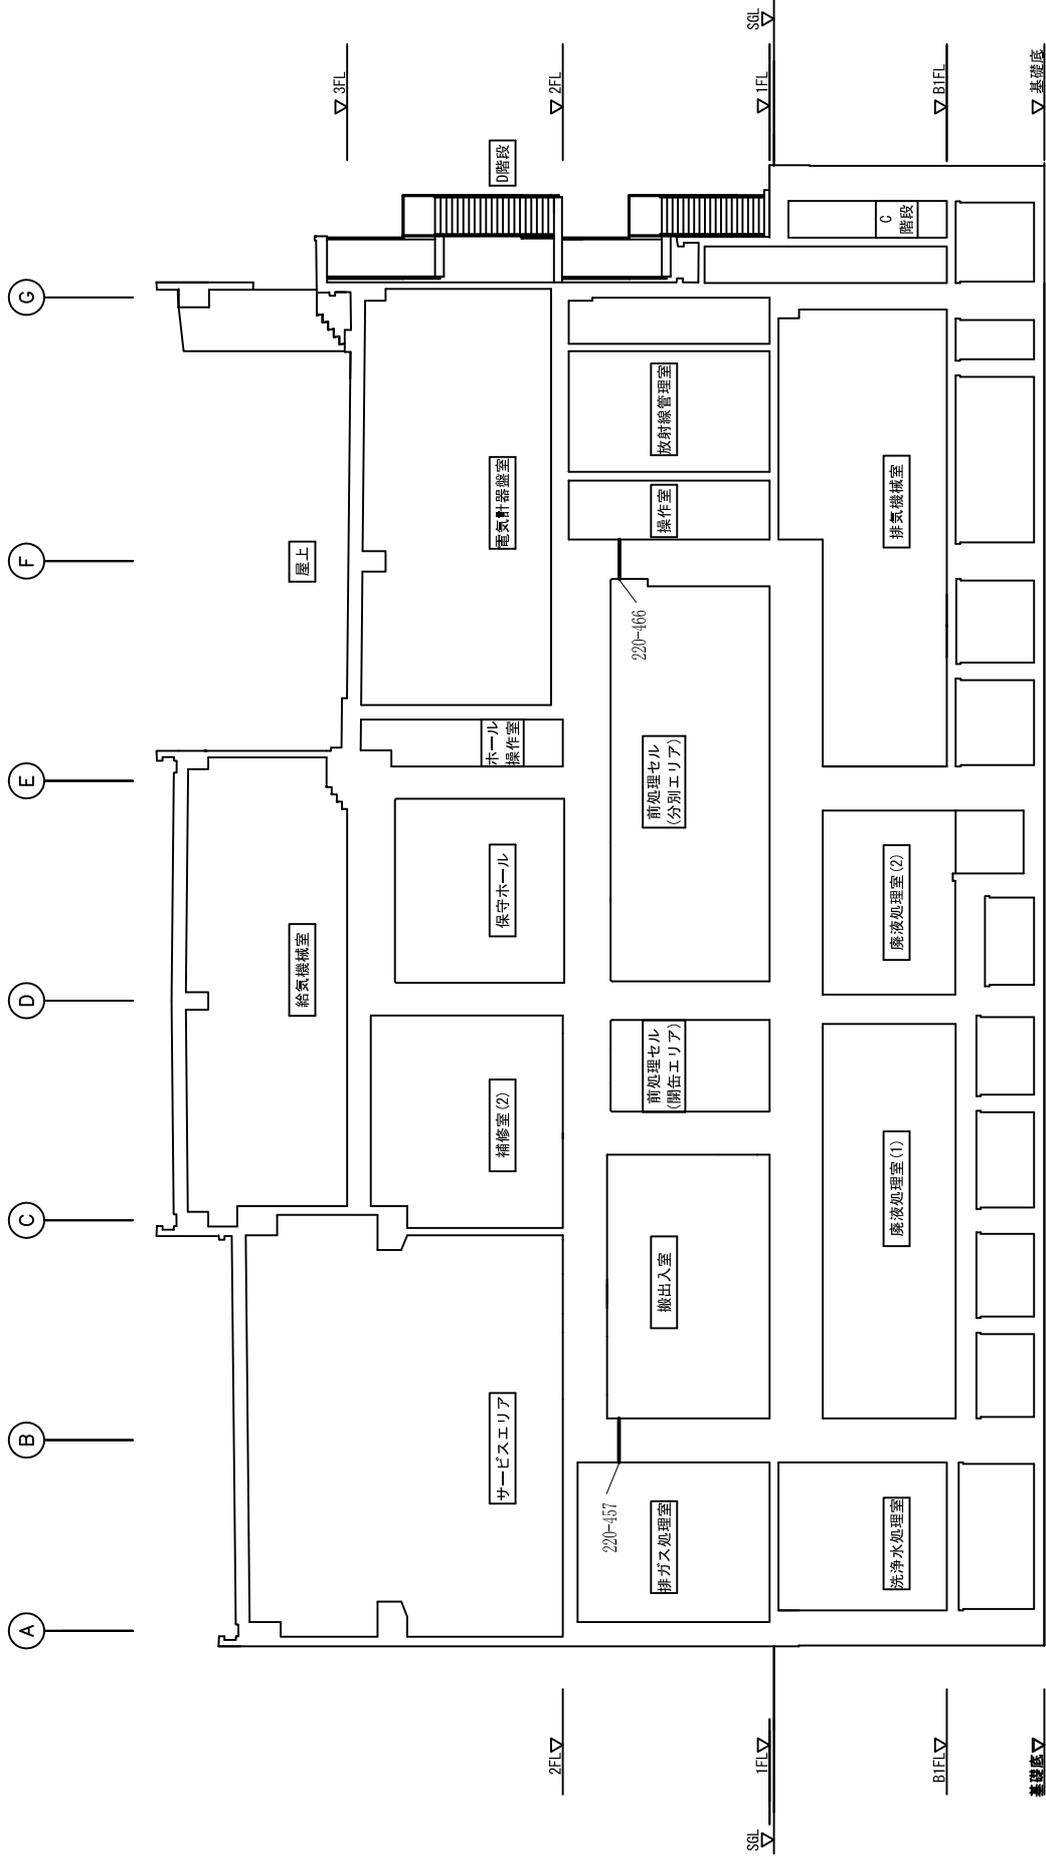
ガス消火設備の配管類 (埋設部) 配置図 (①~②間断面図)
